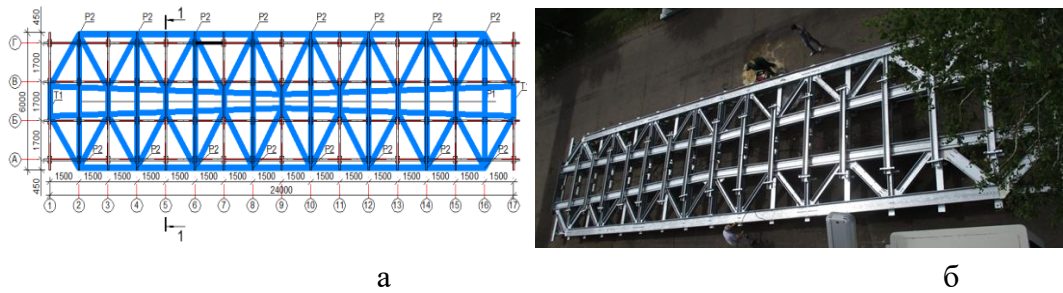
Укладка на стенд ферм пролетом 24 м: а – проектное решение; б – во время испытаний
